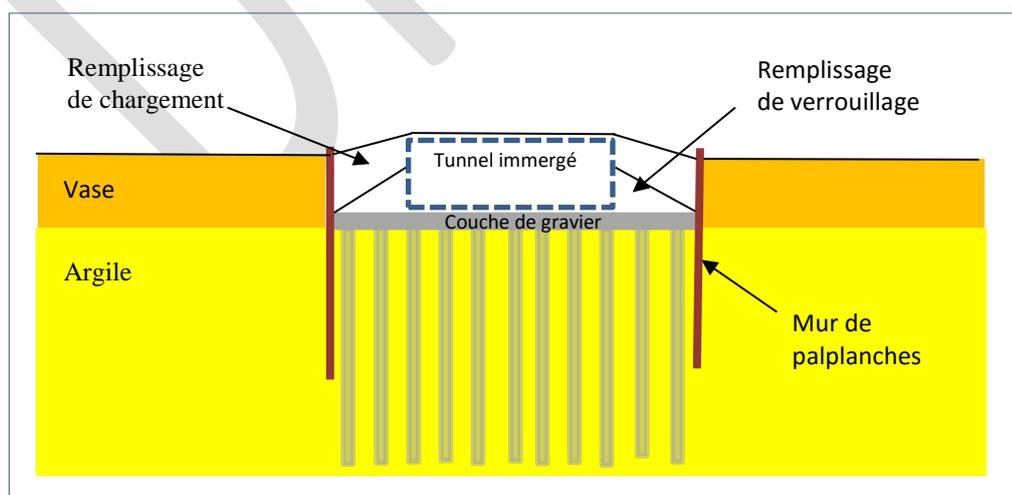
Tunnel immergé dans une tranchée, soutenue par deux murs de palplanche
